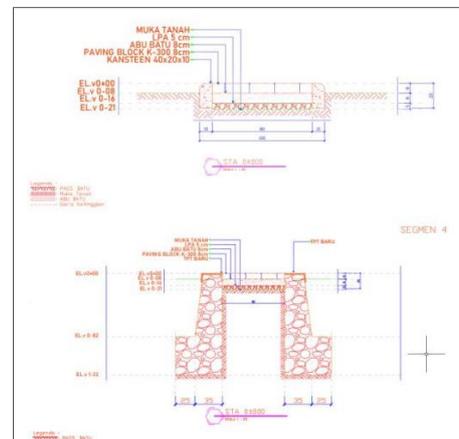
DED Siteplan Segmen Jalan Lingkungan di Kelurahan Margaluyu
